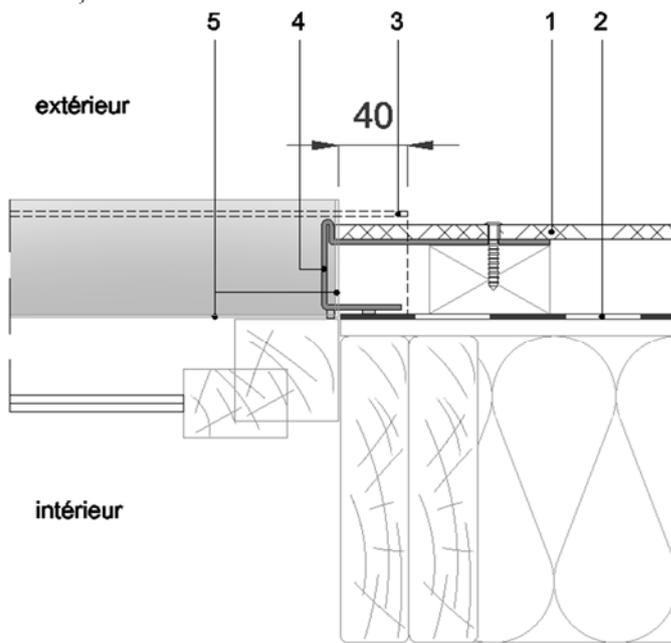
Coupe sur linteau de baie – Pose sur COB
